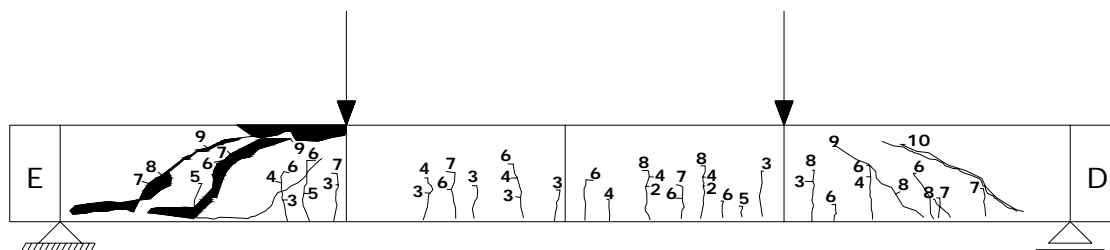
Padrão de fissuração para a viga V60-2 com armadura transversal
